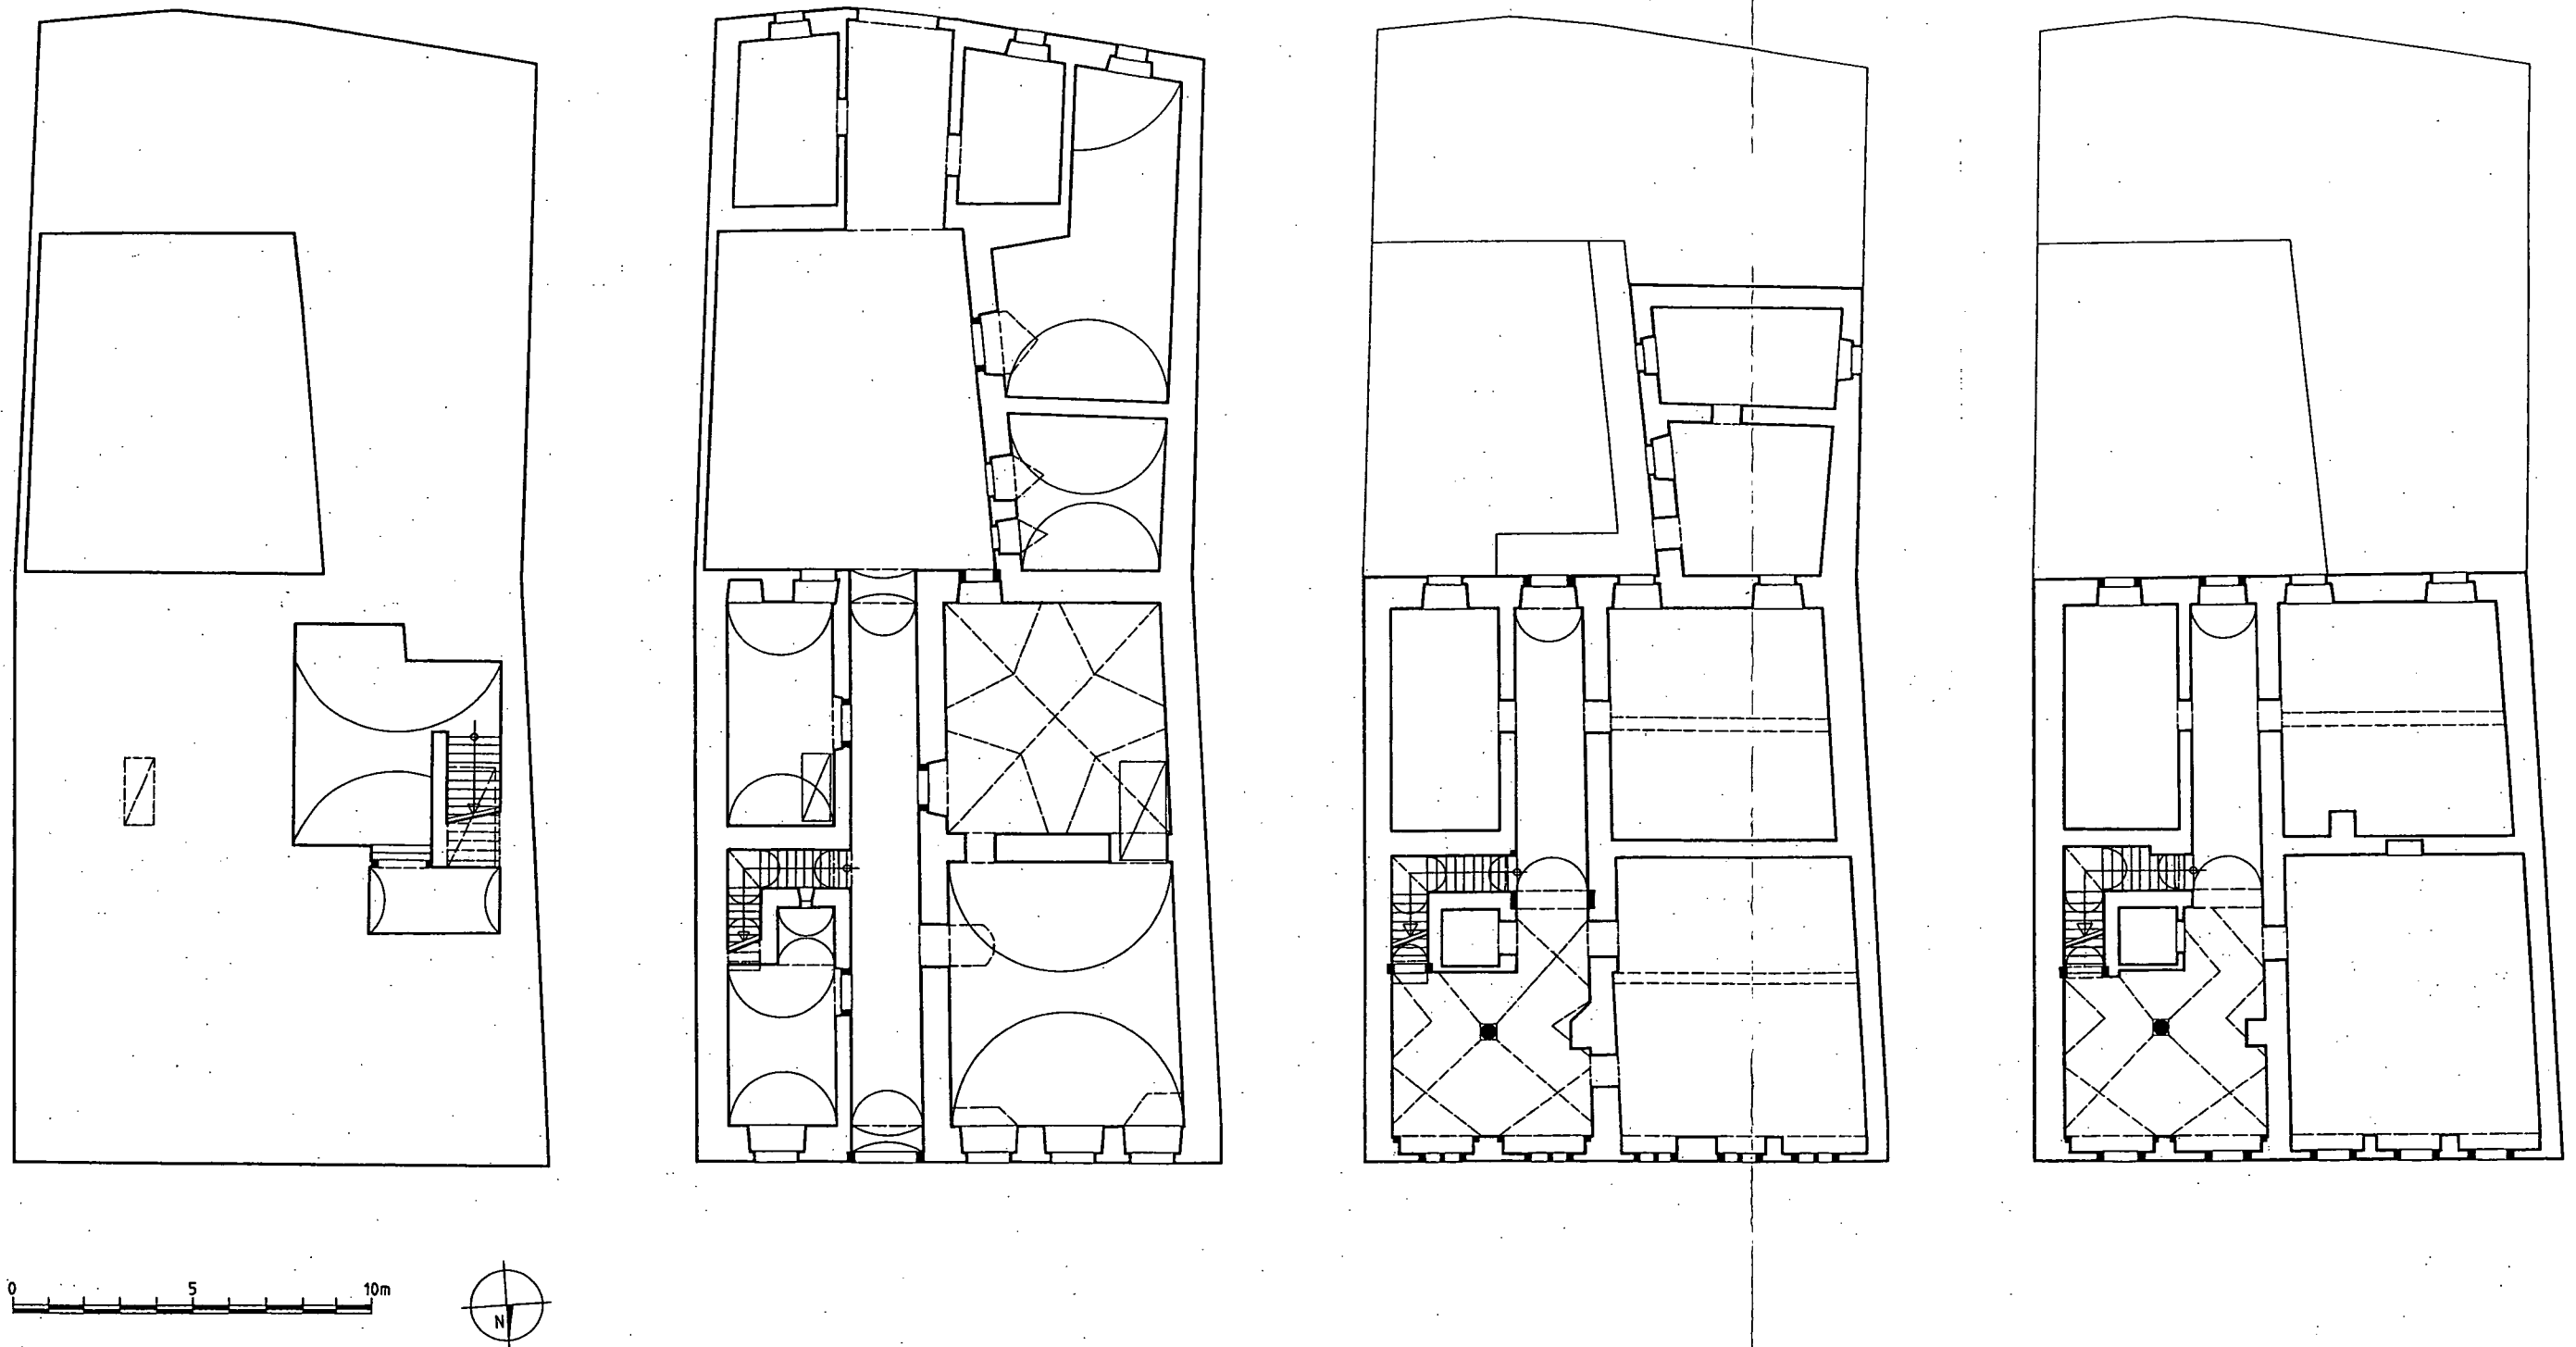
Schmiedstraße 25 – Grundrisse Keller, Erdgeschoss, 1. und 2. Obergeschoss (1:200).
